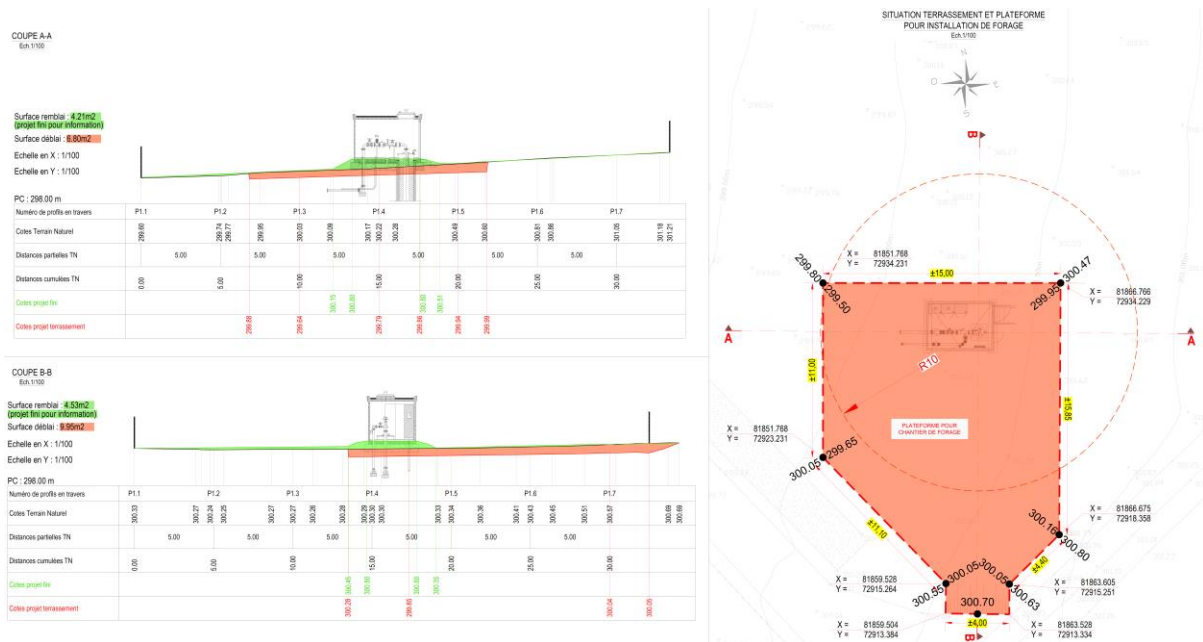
Plan Terrassement - Situation - Coupes des Brunnenstandortes SH 15-7 mit Darstellung des terrassierten Arbeitsbereiches (rot) sowie Geländeschnitten. Quelle: TR-Engineering, 2019
